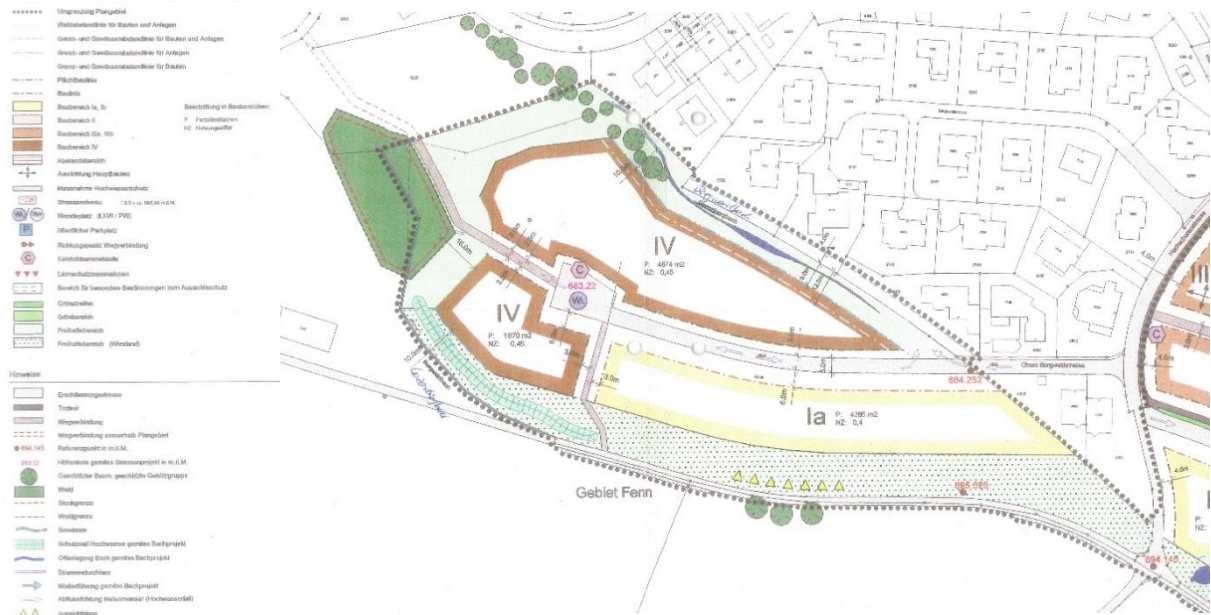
Ausschnitt rechtsgültiger Überbauungsplan Fenn-Geissberg, Bereich III Etappe
